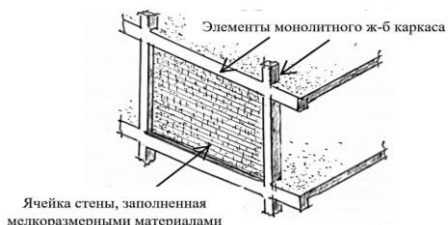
Фрагмент каркасного здания с элементом и заполняющей стены из мелкогабаритных элементов
